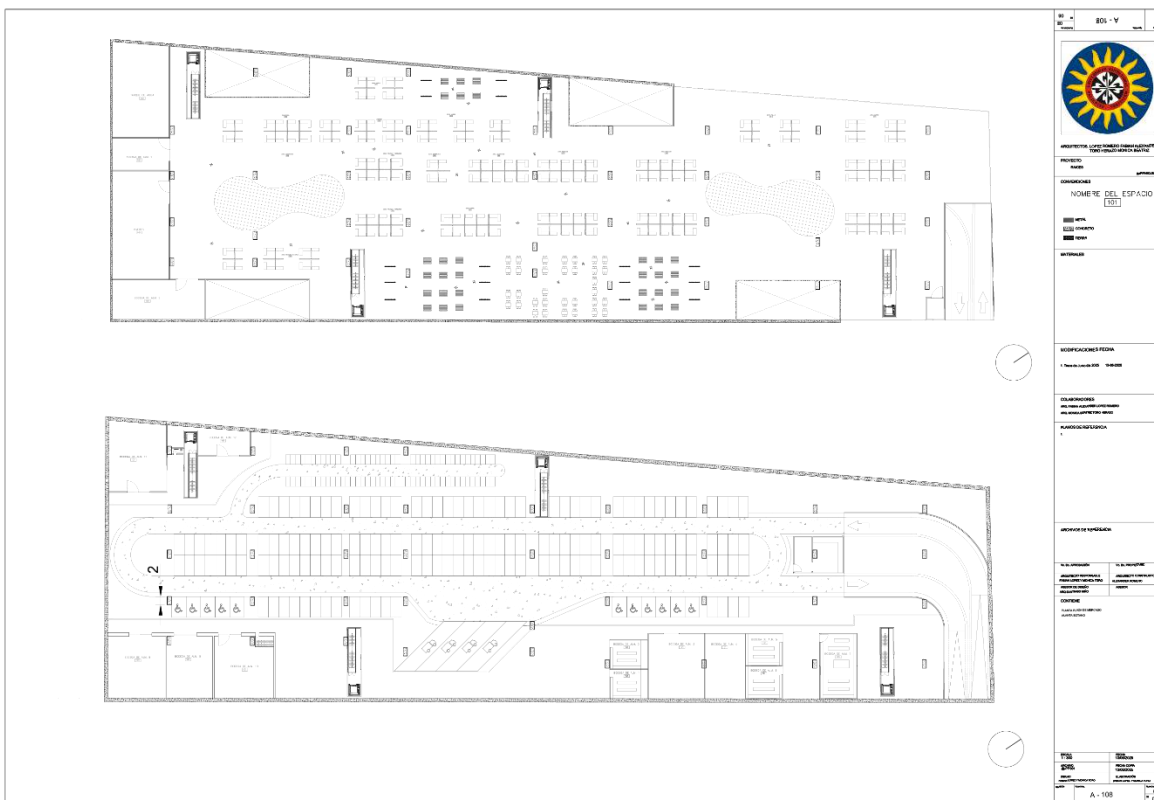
Planimetría Planta sótano y Plaza de mercado. Fuente: Elaboración propia.
